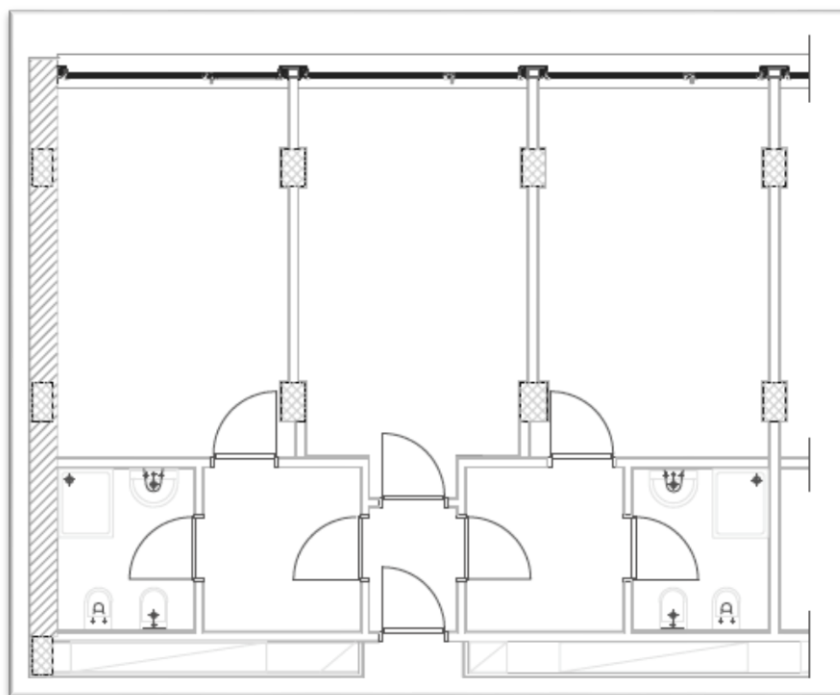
Pianta tipologia Silver- Fonte: archivio In-Domus
